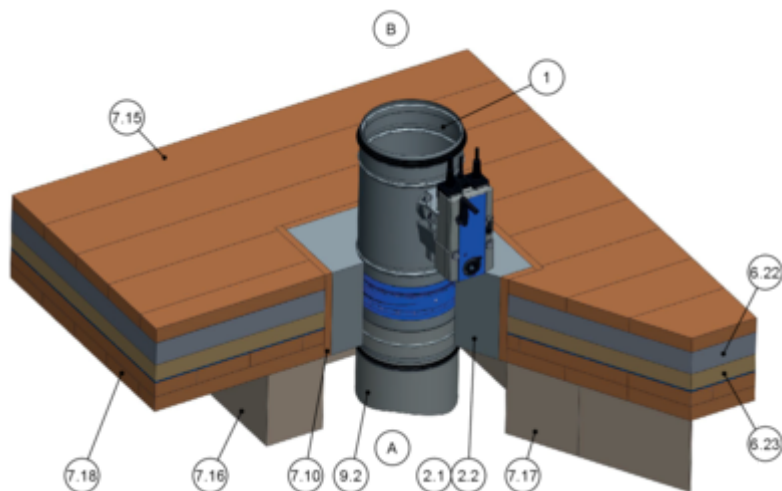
Installazione a secco senza malta con kit d'installazione TQ2 in soffitto con travi di legno/in legno lamellare, sospesa (illustrazione rappresentativa, esecuzione alternativa del soffitto possibile su richiesta)
